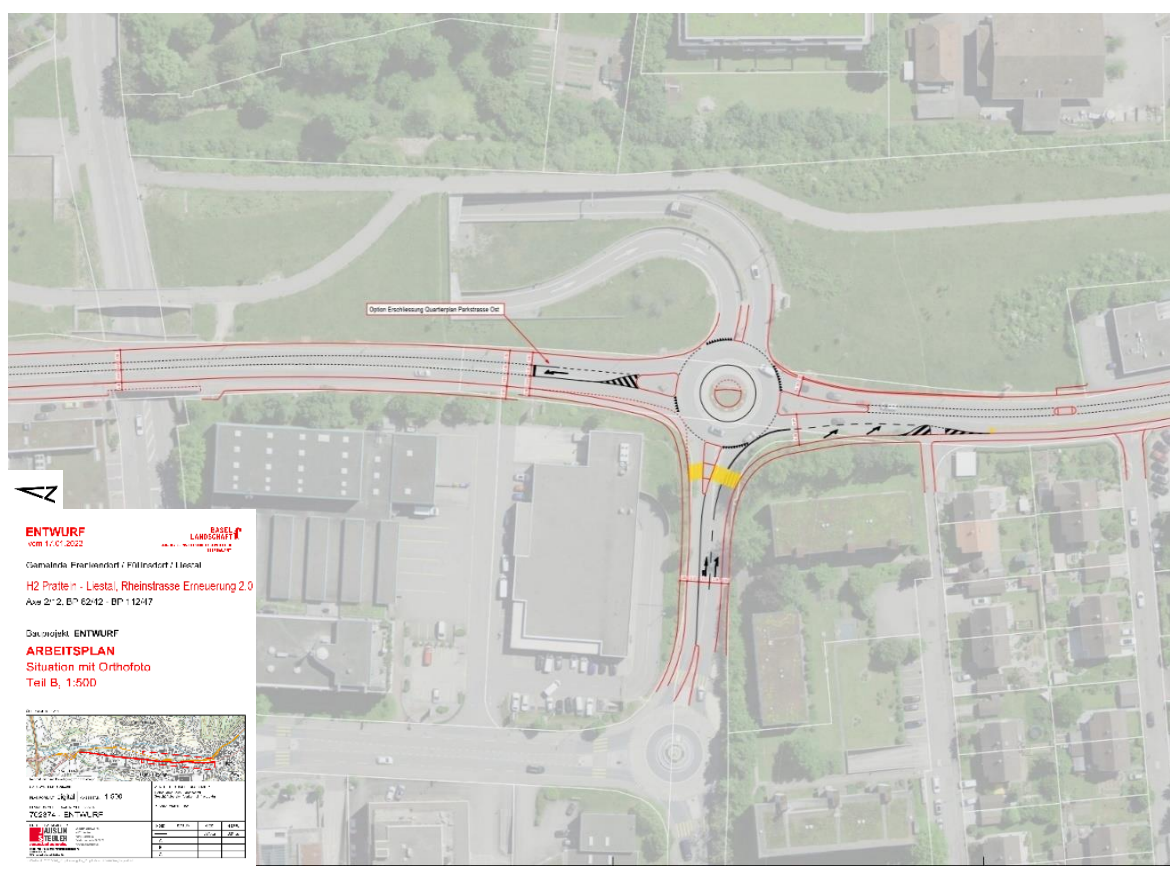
Vorabzug Auflageprojekt Rheinstrasse
